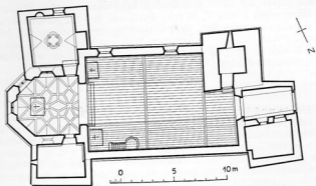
Grundriss. — Maßstab 1:300.
